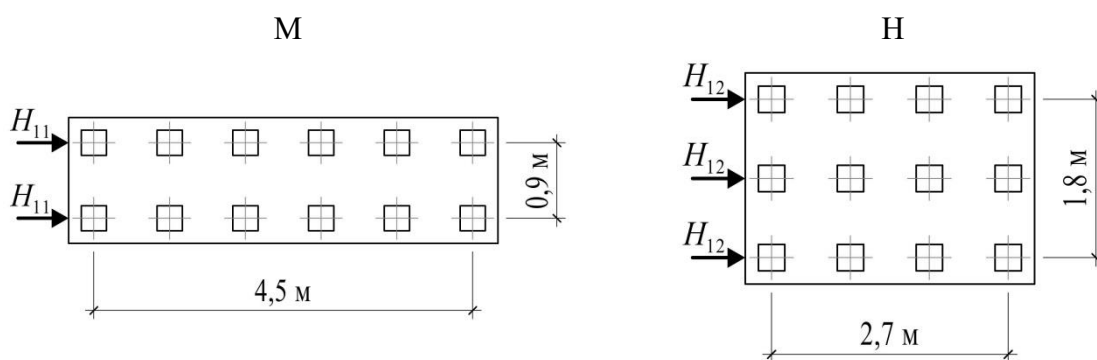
Схемы горизонтально нагруженных фундаментов: М – двухрядная группа из 12 свай; Н – трехрядная группа из 12 свай
